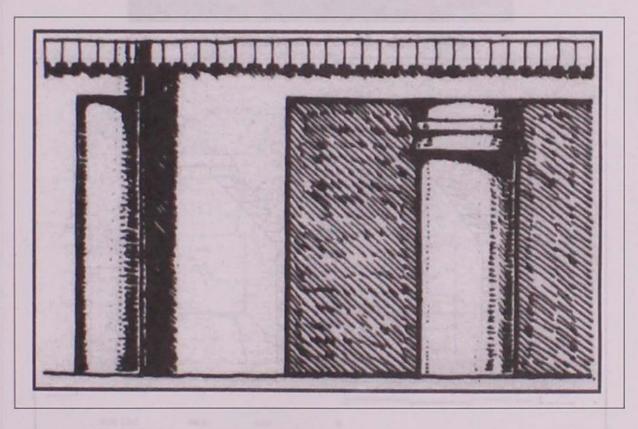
Detalle de la fachada del edificio 1 de Channá
